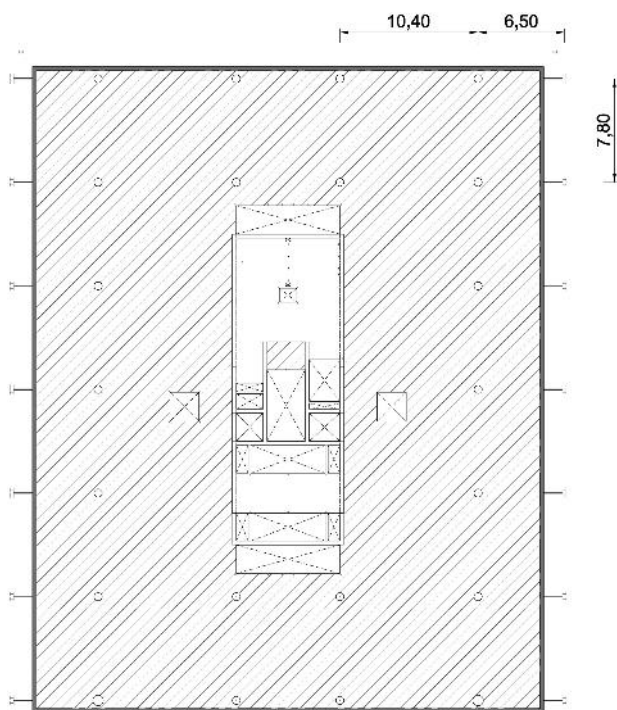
Planta tipo de bloque de oficinas. Bloque C.
